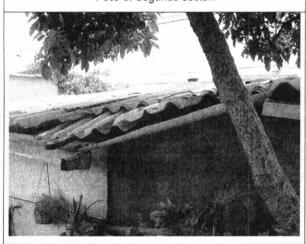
Cubierta de segundo sector con falta de alineamiento horizontal.
